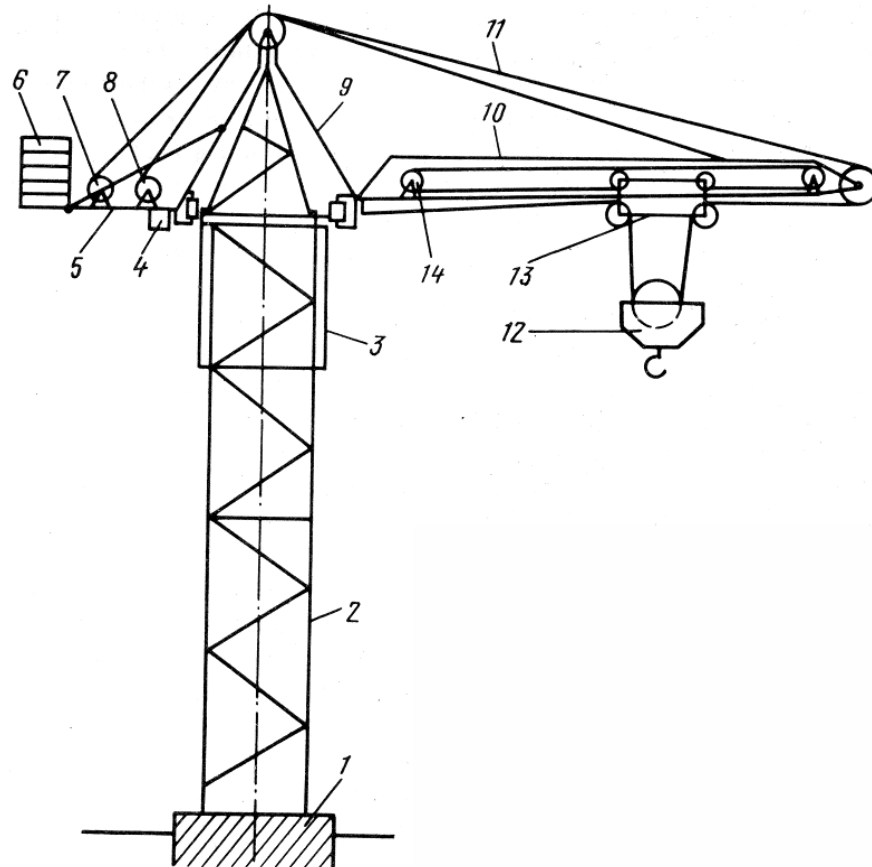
Схема баштового крана з неповоротною баштою: фундамент; 2- башта; 3- кабіна керування; 4- механізм повороту; 5- консоль; противага; 7,8- вантажна та стрілова лебідки; 9- наголовник; 10- стріла; 11-вантажний канат; 12- гакова підвіска; 13- вантажний візок; 14- лебідка переміщення візка
